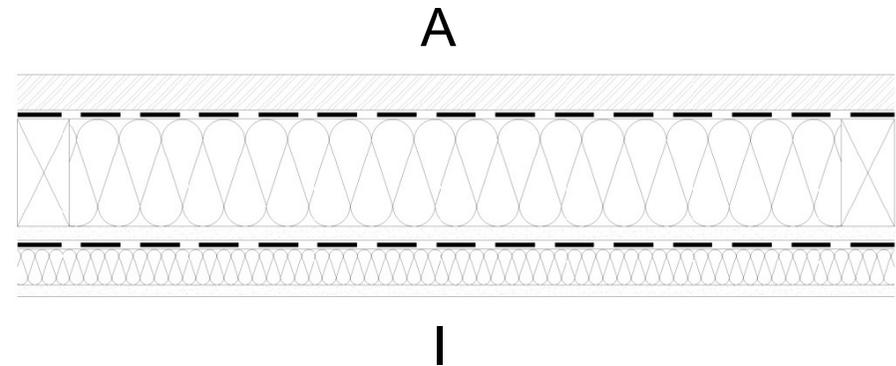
Stadl, Hozboxen, Deckenaufbau
